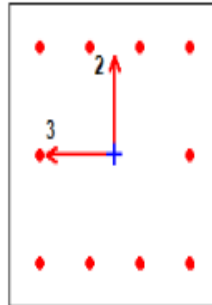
Area de Acero en las Columnas C-1 y C-2
